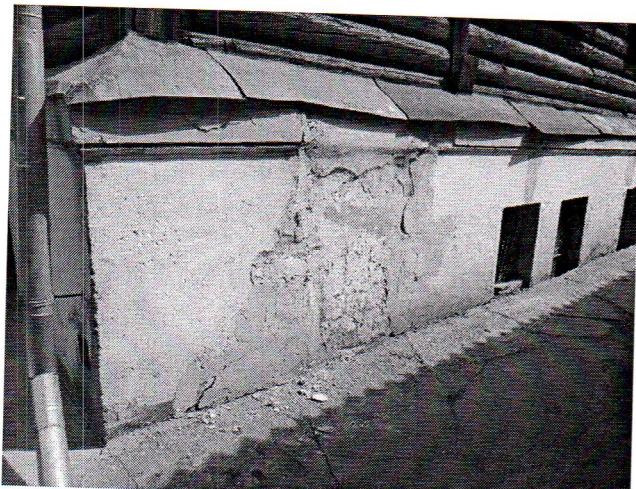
Деформация стены на западном фасаде месте заложенного оконного проема.
